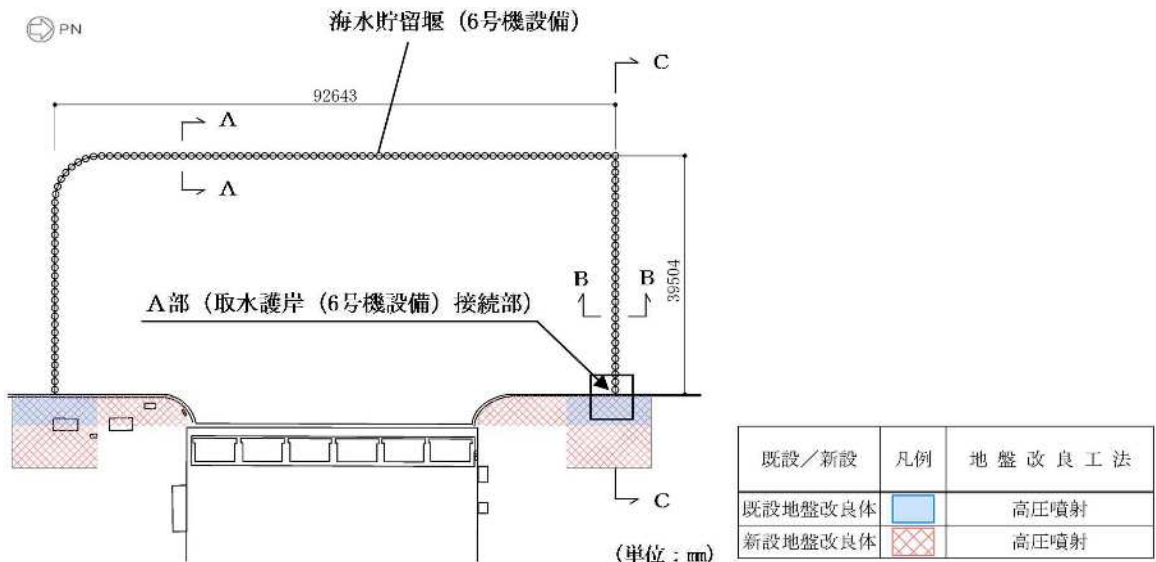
(1) 海水貯留堰（6号機設備）の平面図
